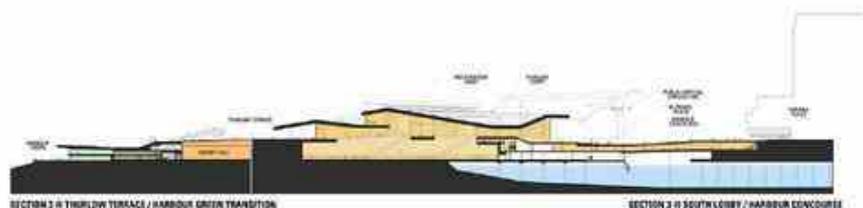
Denah Vancouver *Convention Center*, Vancouver
